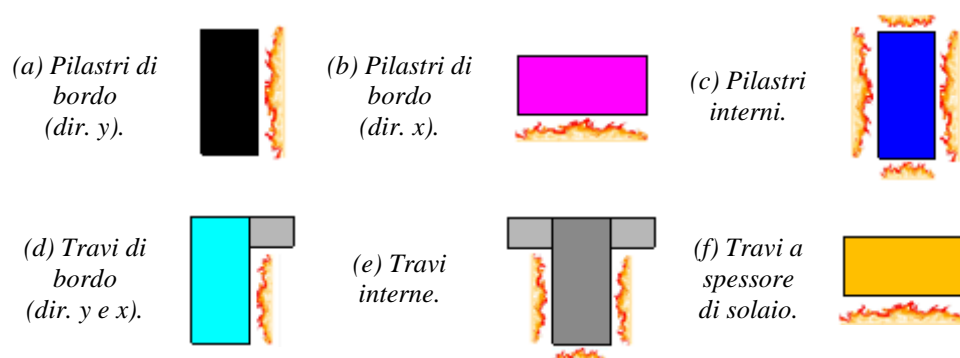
Esposizione all'azione del fuoco degli elementi strutturali in c.a..
